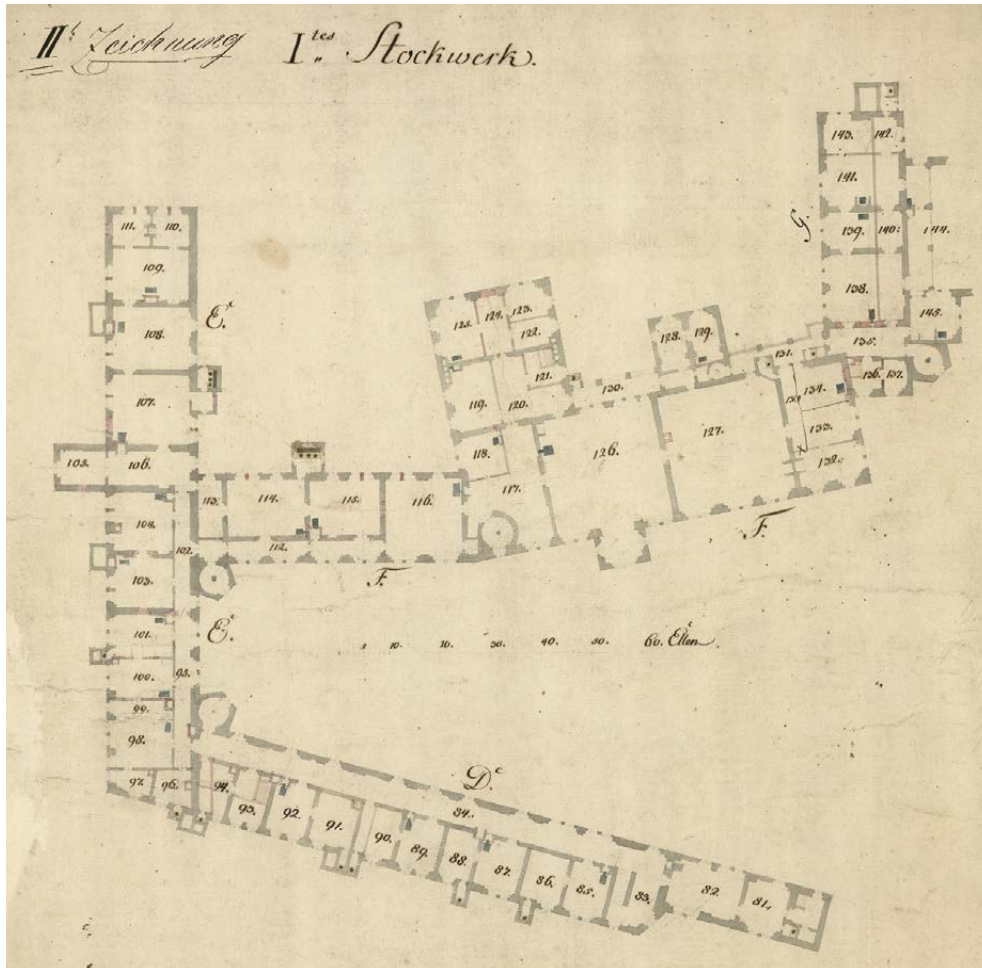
Prettin, Schloss Lichtenburg, erstes Obergeschoss, Grundriss, 1810–1812. LASA Merseburg, C 48 IX, Lit. K Nr. 34
